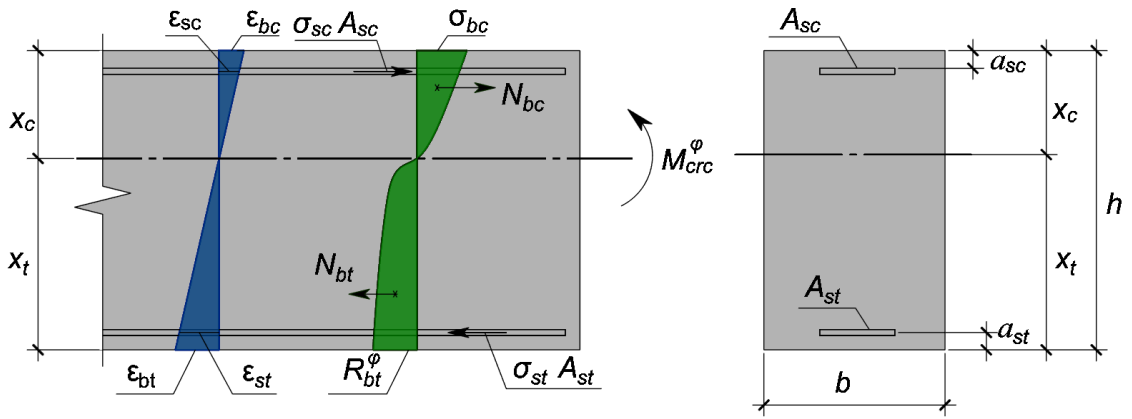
Расчетная схема напряженно-деформированного состояния изгибаемого железобетонного элемента прямоугольного сечения непосредственно перед появлением первой трещины в растянутой зоне бетона
